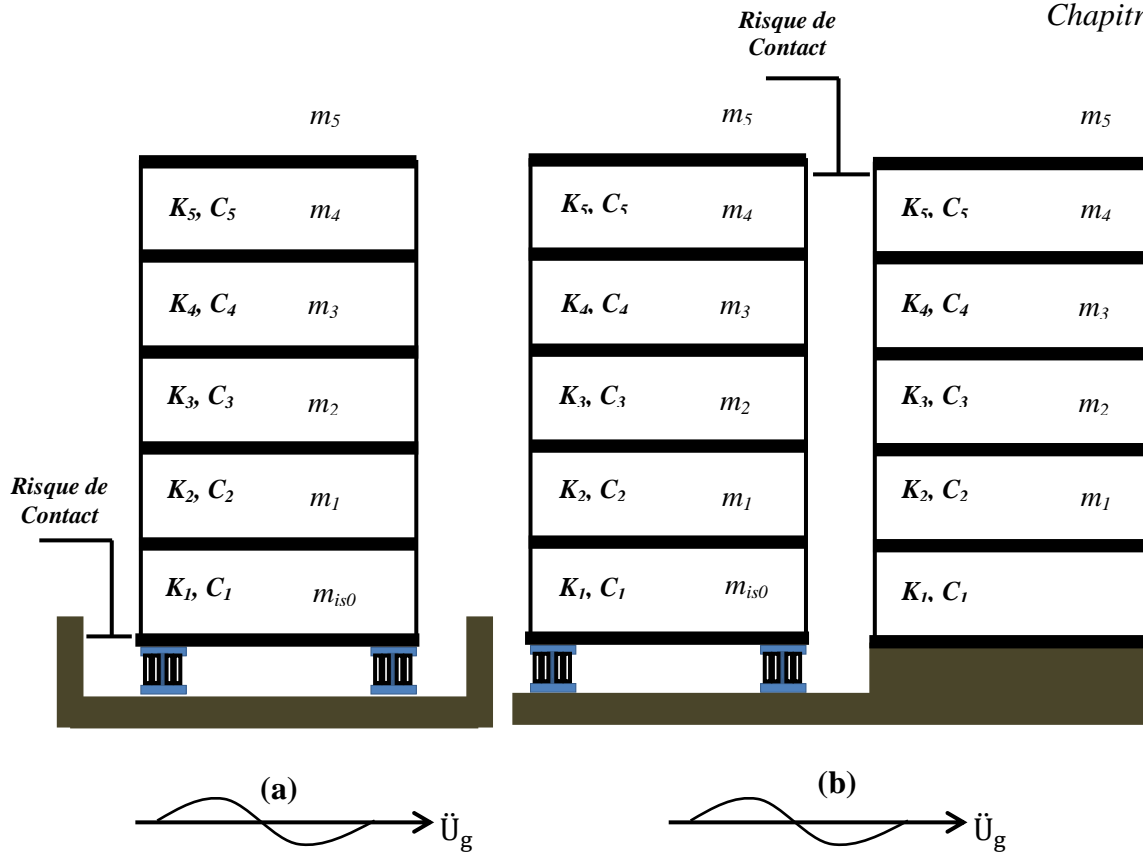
(a) Structure isolée au voisinage d'un mur de soutènement (impact au niveau de la base), (b) Structure isolée au voisinage d'une structure conventionnelle (impact au niveau des planchers).
